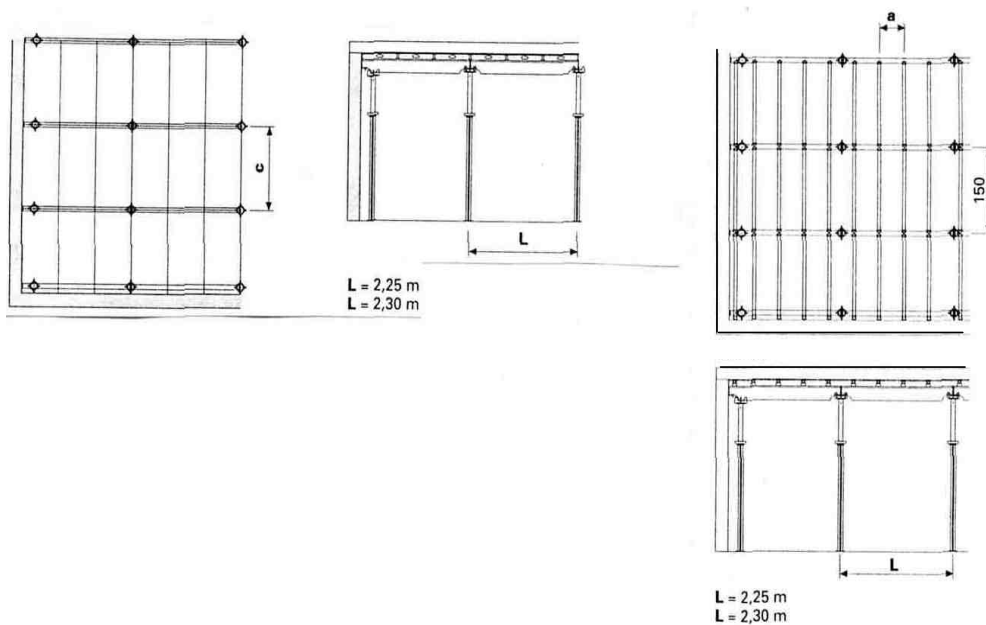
Щитова опалубка перекриттів на стійках з падаючою головкою
